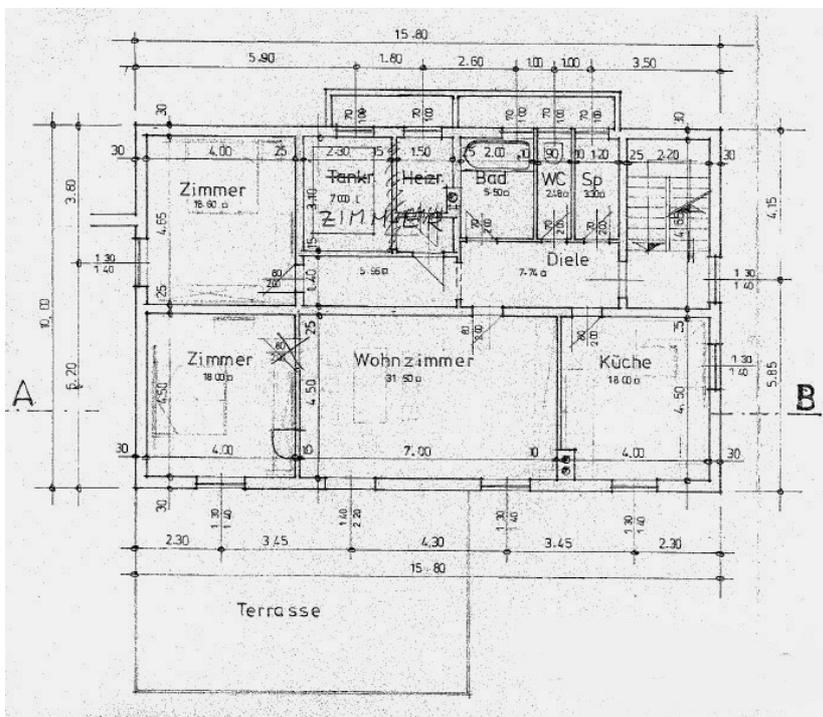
Grundriss Erdgeschoss Bestand [47]
